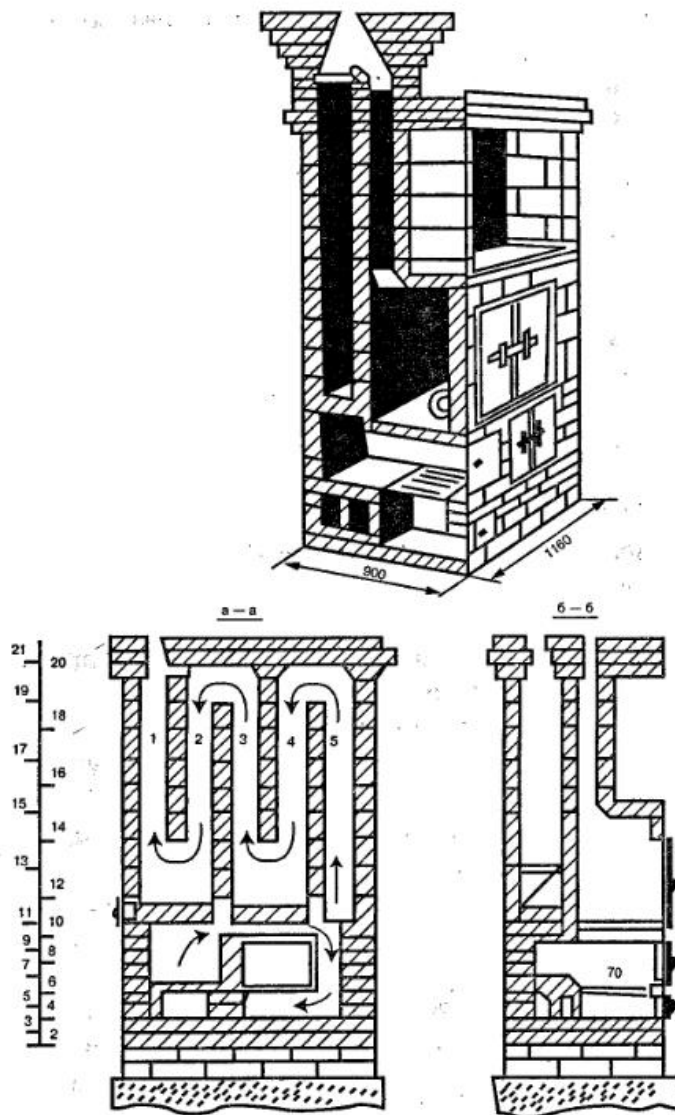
Разрезы и порядовки отопительно-варочной печи
